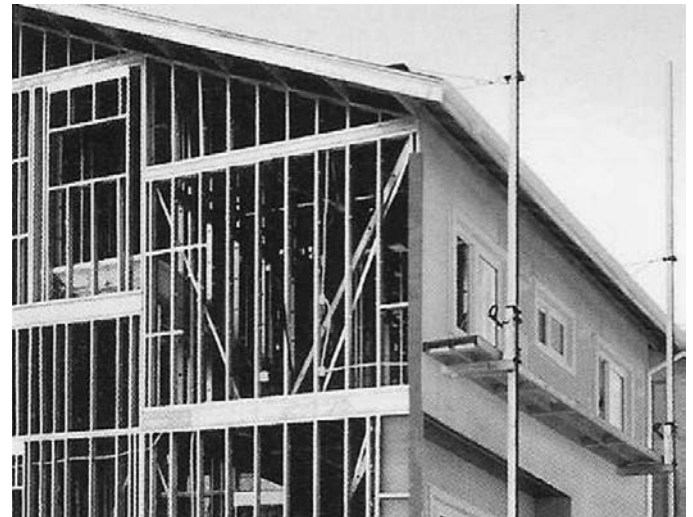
Montaje de una casa en Steel Framing, São Paulo- SP (Fuente: Construtora Sequência)
